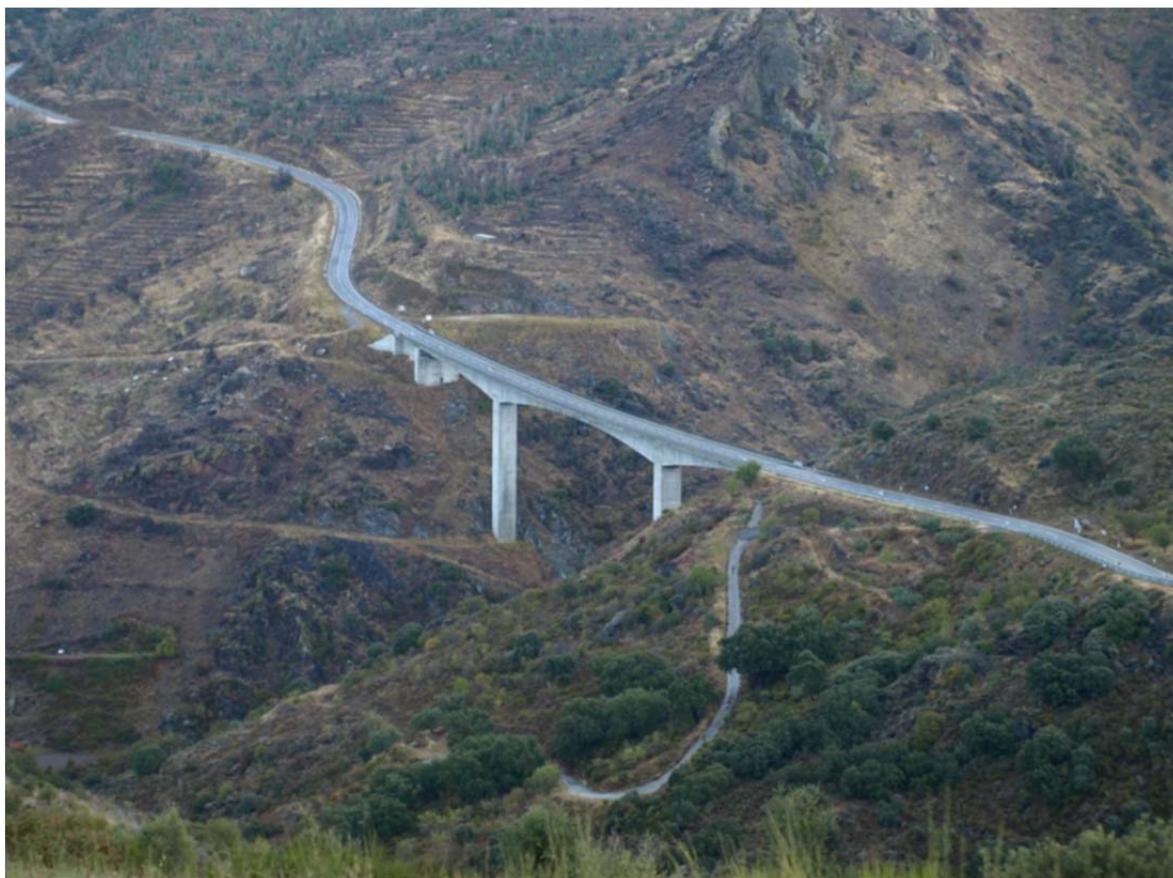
Observação estrutural da ponte sobre o rio Angueira
